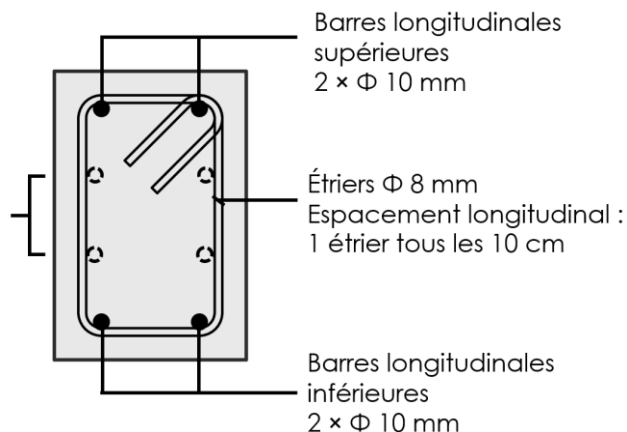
Principe de ferrailage des asselets (vue en coupe transversale)
